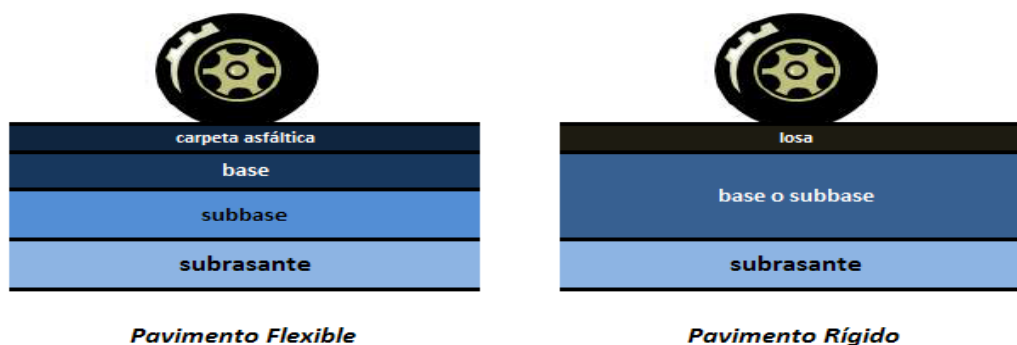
Esquema del paquete estructural para pavimento flexible y rígido
